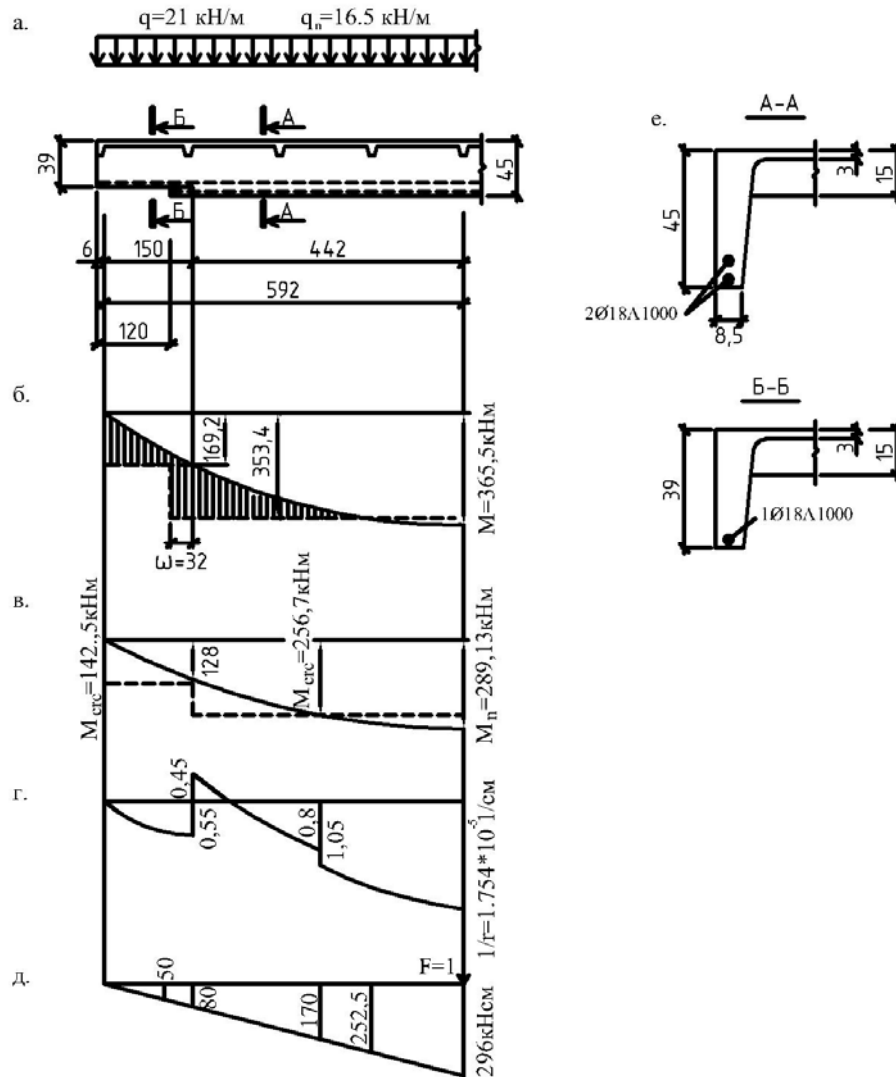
Железобетонная плита с ребром ступенчатого очертания в растянутой зоне (вид 2).
